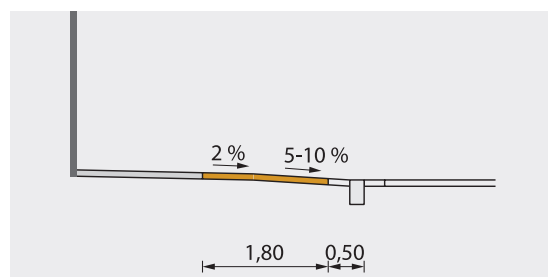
Piste cyclable à hauteur d'une traversée piétonne, coupe transversale.
